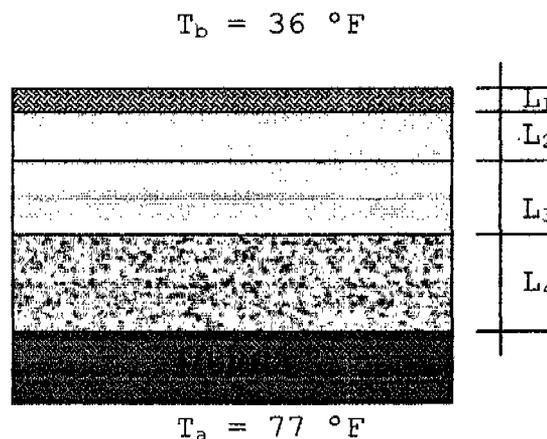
CORTE TRANSVERSAL DE LA ESTRUCTURA DEL PISO
